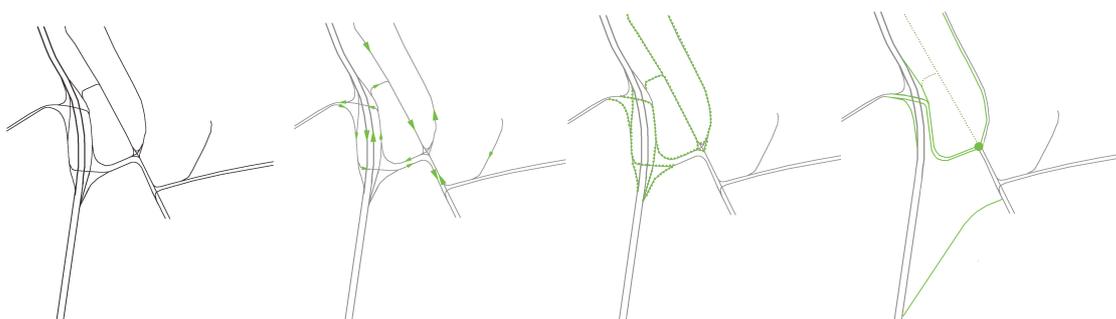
a 107 (respectivamente): Zoom das vias de trânsito a rever; Sistema actual com sentidos de trânsito assinalado a verde; Ligações viárias a serem restructuradas; Proposta de alteração das ligações internas (linha pontuada – trânsito restringido a transportes públicos e rotunda na ligação da Al. Linhas de Torres e Rua do Lumiar)
